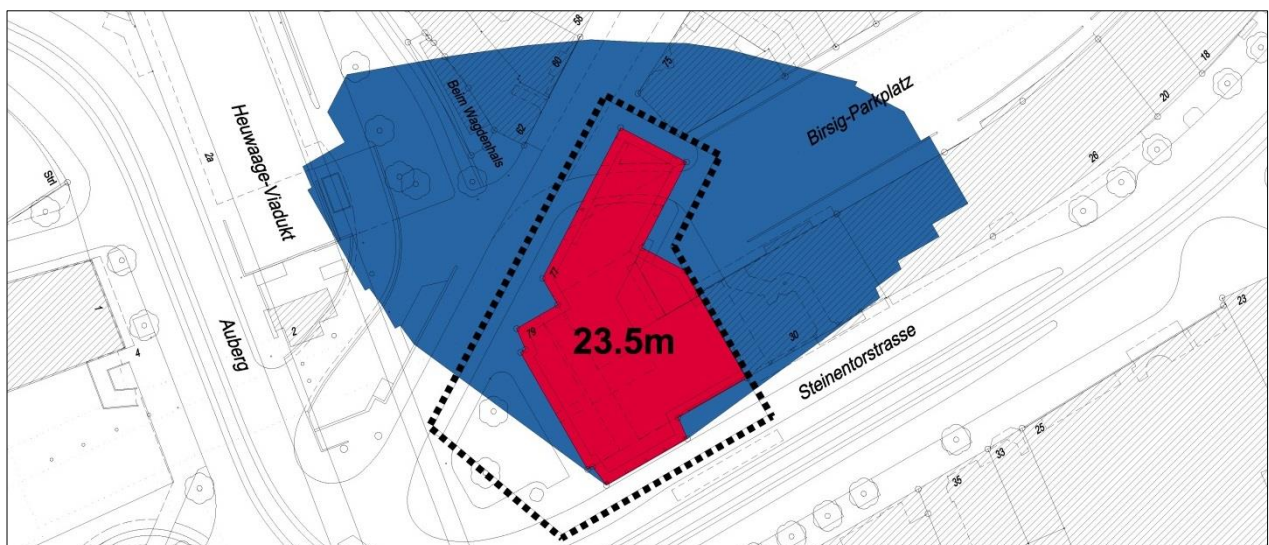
Zwei-Stunden-Schatten einer zonenkonformen Bebauung in der Zone 6. Höhe = 23.5 m. (Kein Massstab, Plan genordet)
